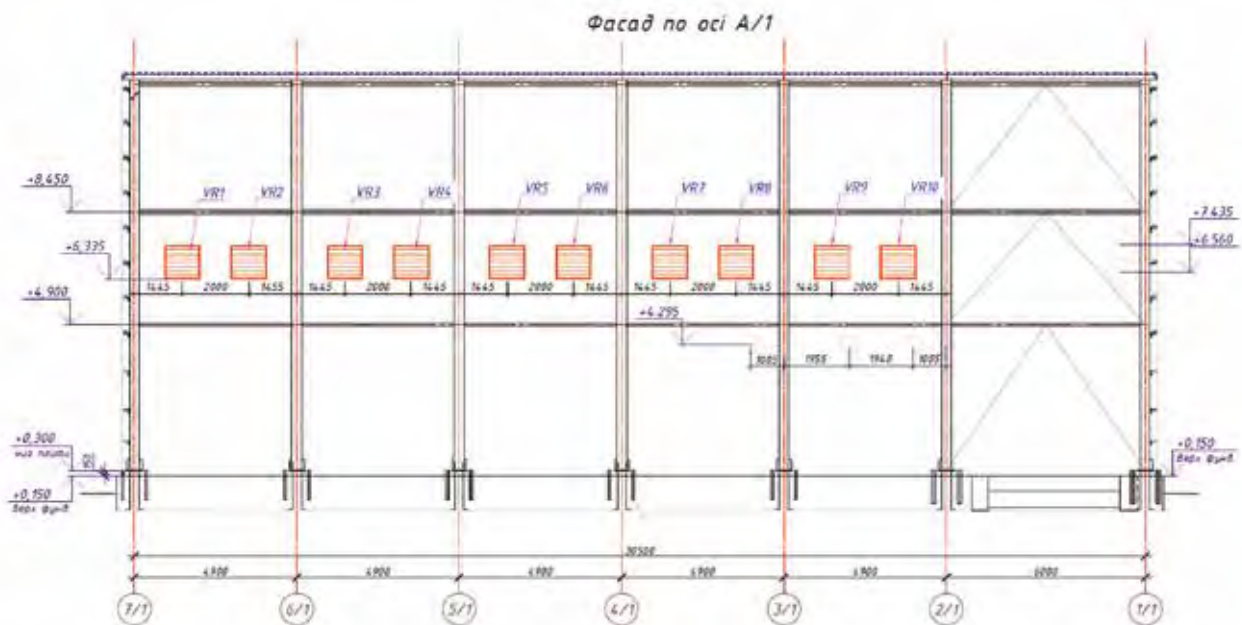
Розташування приливних вентиляційних решіток (VR1–VR10) на фасаді будівлі; розробка автора
